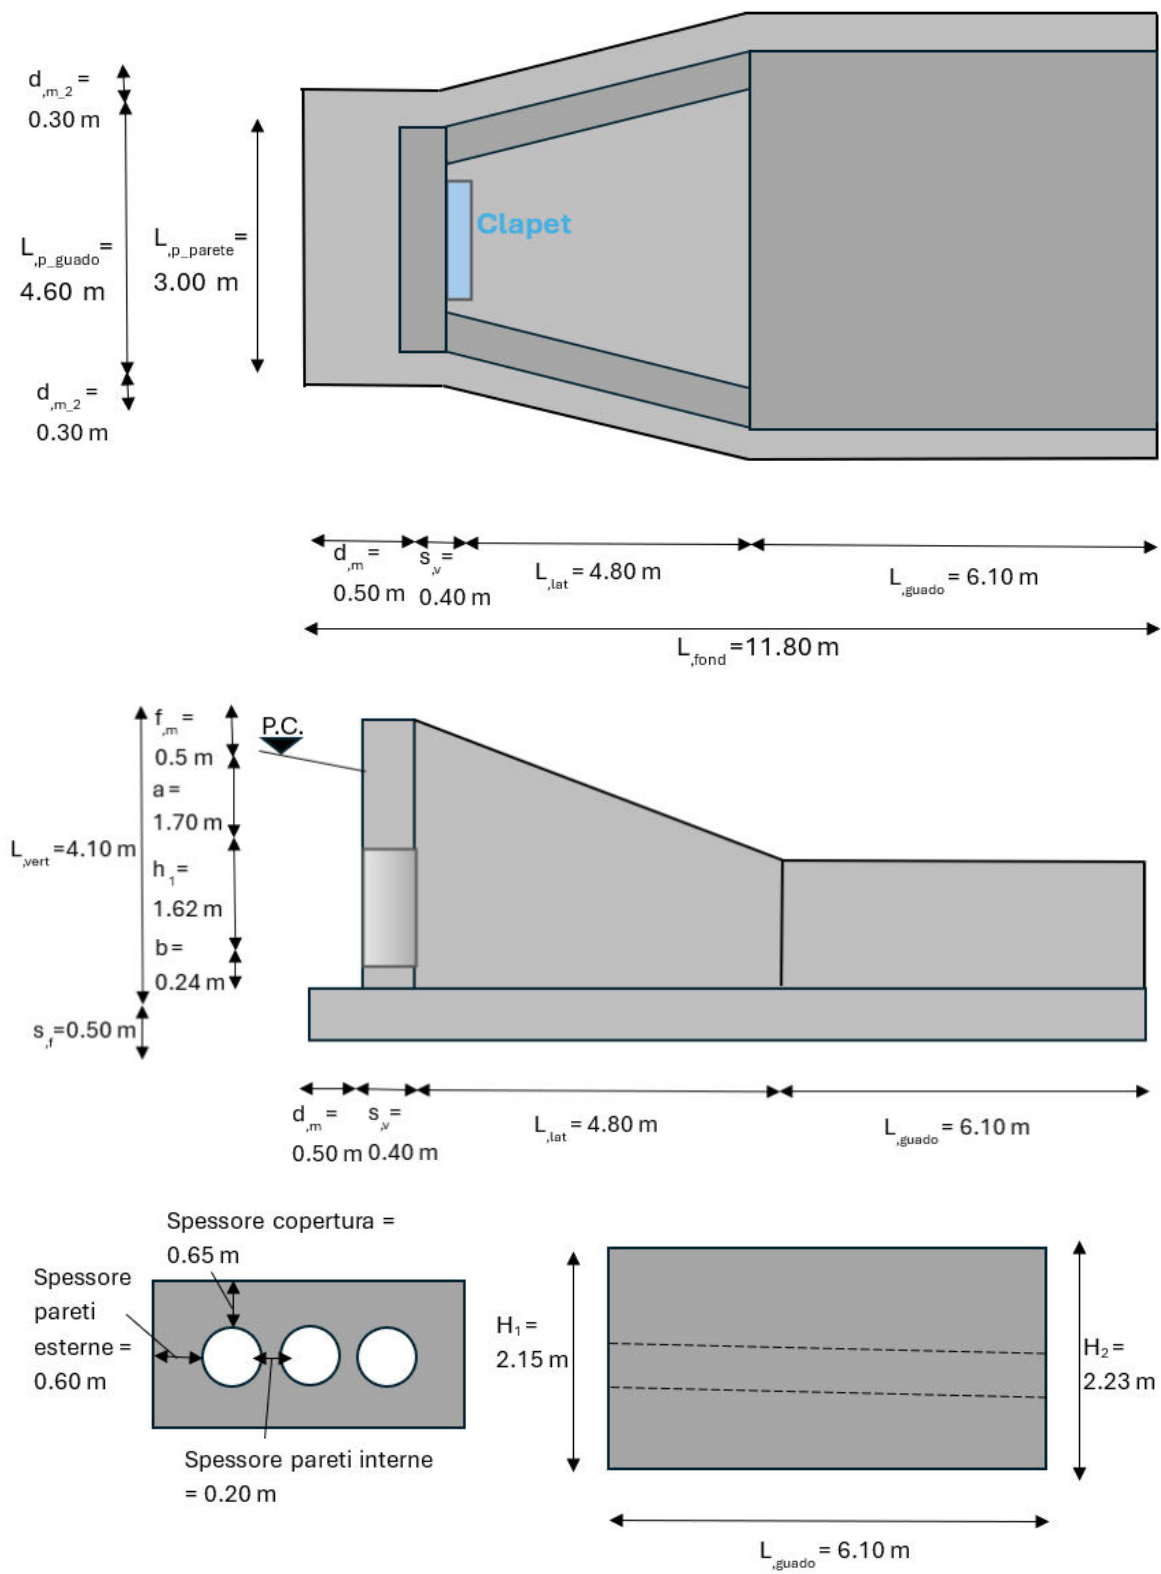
Pianta (in alto), sezione longitudinale (al centro) e sezioni trasversale e longitudinale del solo guado (in basso) del manufatto in c.a. di protezione dello scarico n.37
